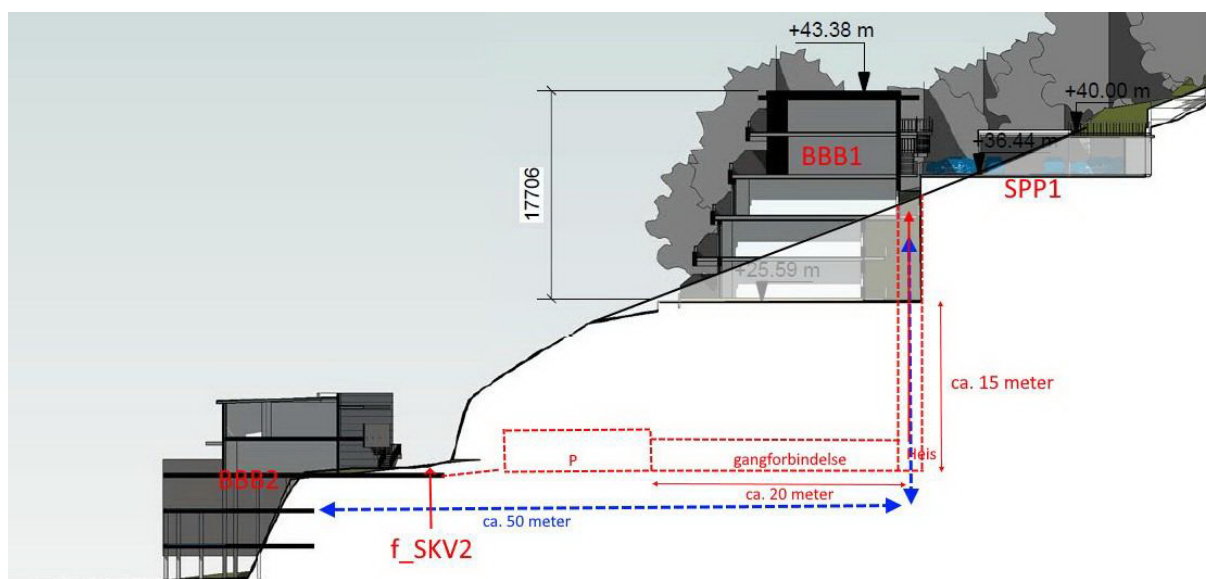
Terrangsnitt som viser alternativ 1. Terrasseblokka flyttes lenger ned i terrenget og med parkering i underetasje vist med rødt stiplest strek.
